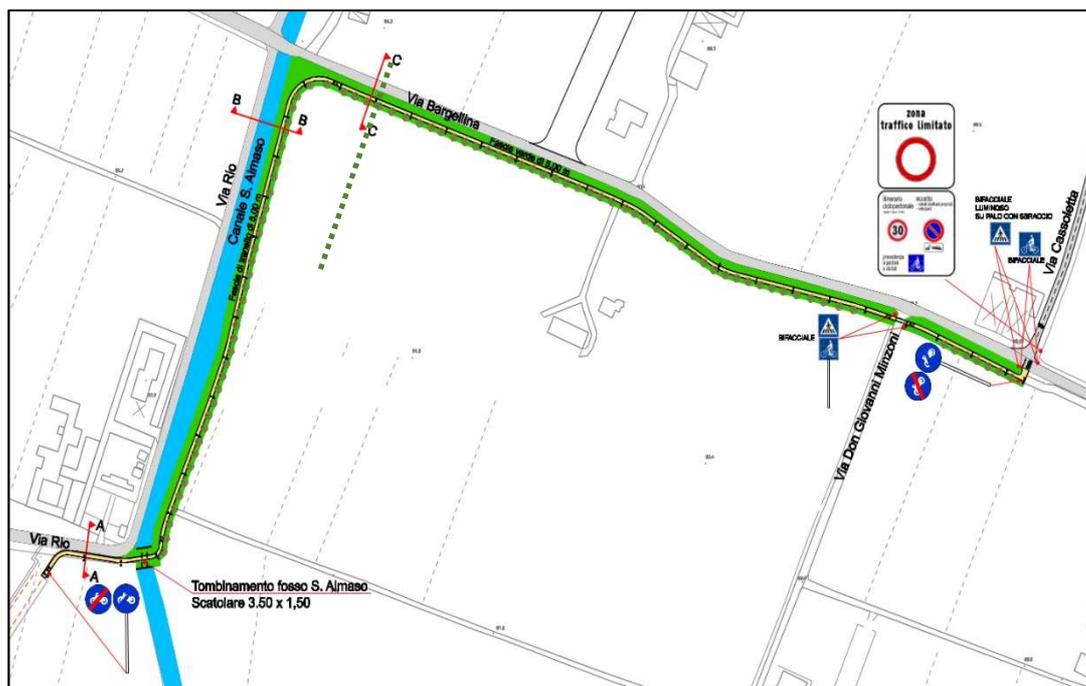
(estratto) Progetto delle opere infrastrutturali – tratto via Rio, via Baricella e intersezione con la via Cassoletta
